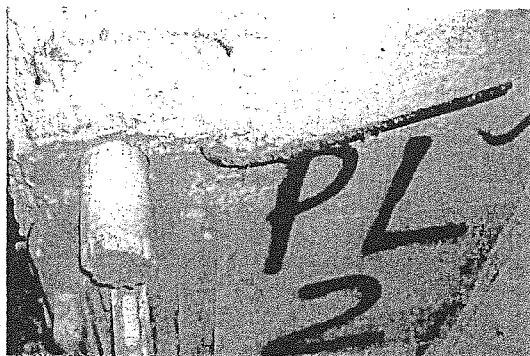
Prelievo di carota in calcestruzzo Φ 80 mm (T4)
